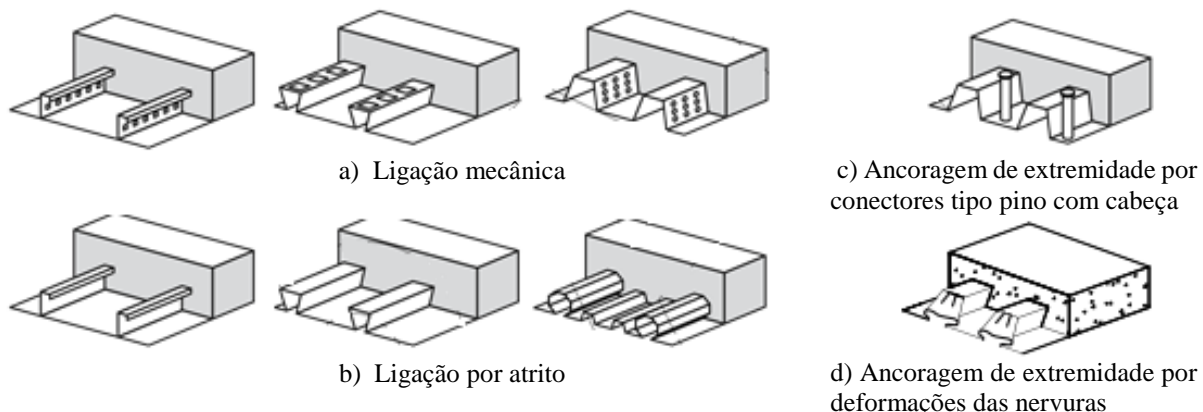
Fôrmas de aço para as lajes mistas de aço e concreto
